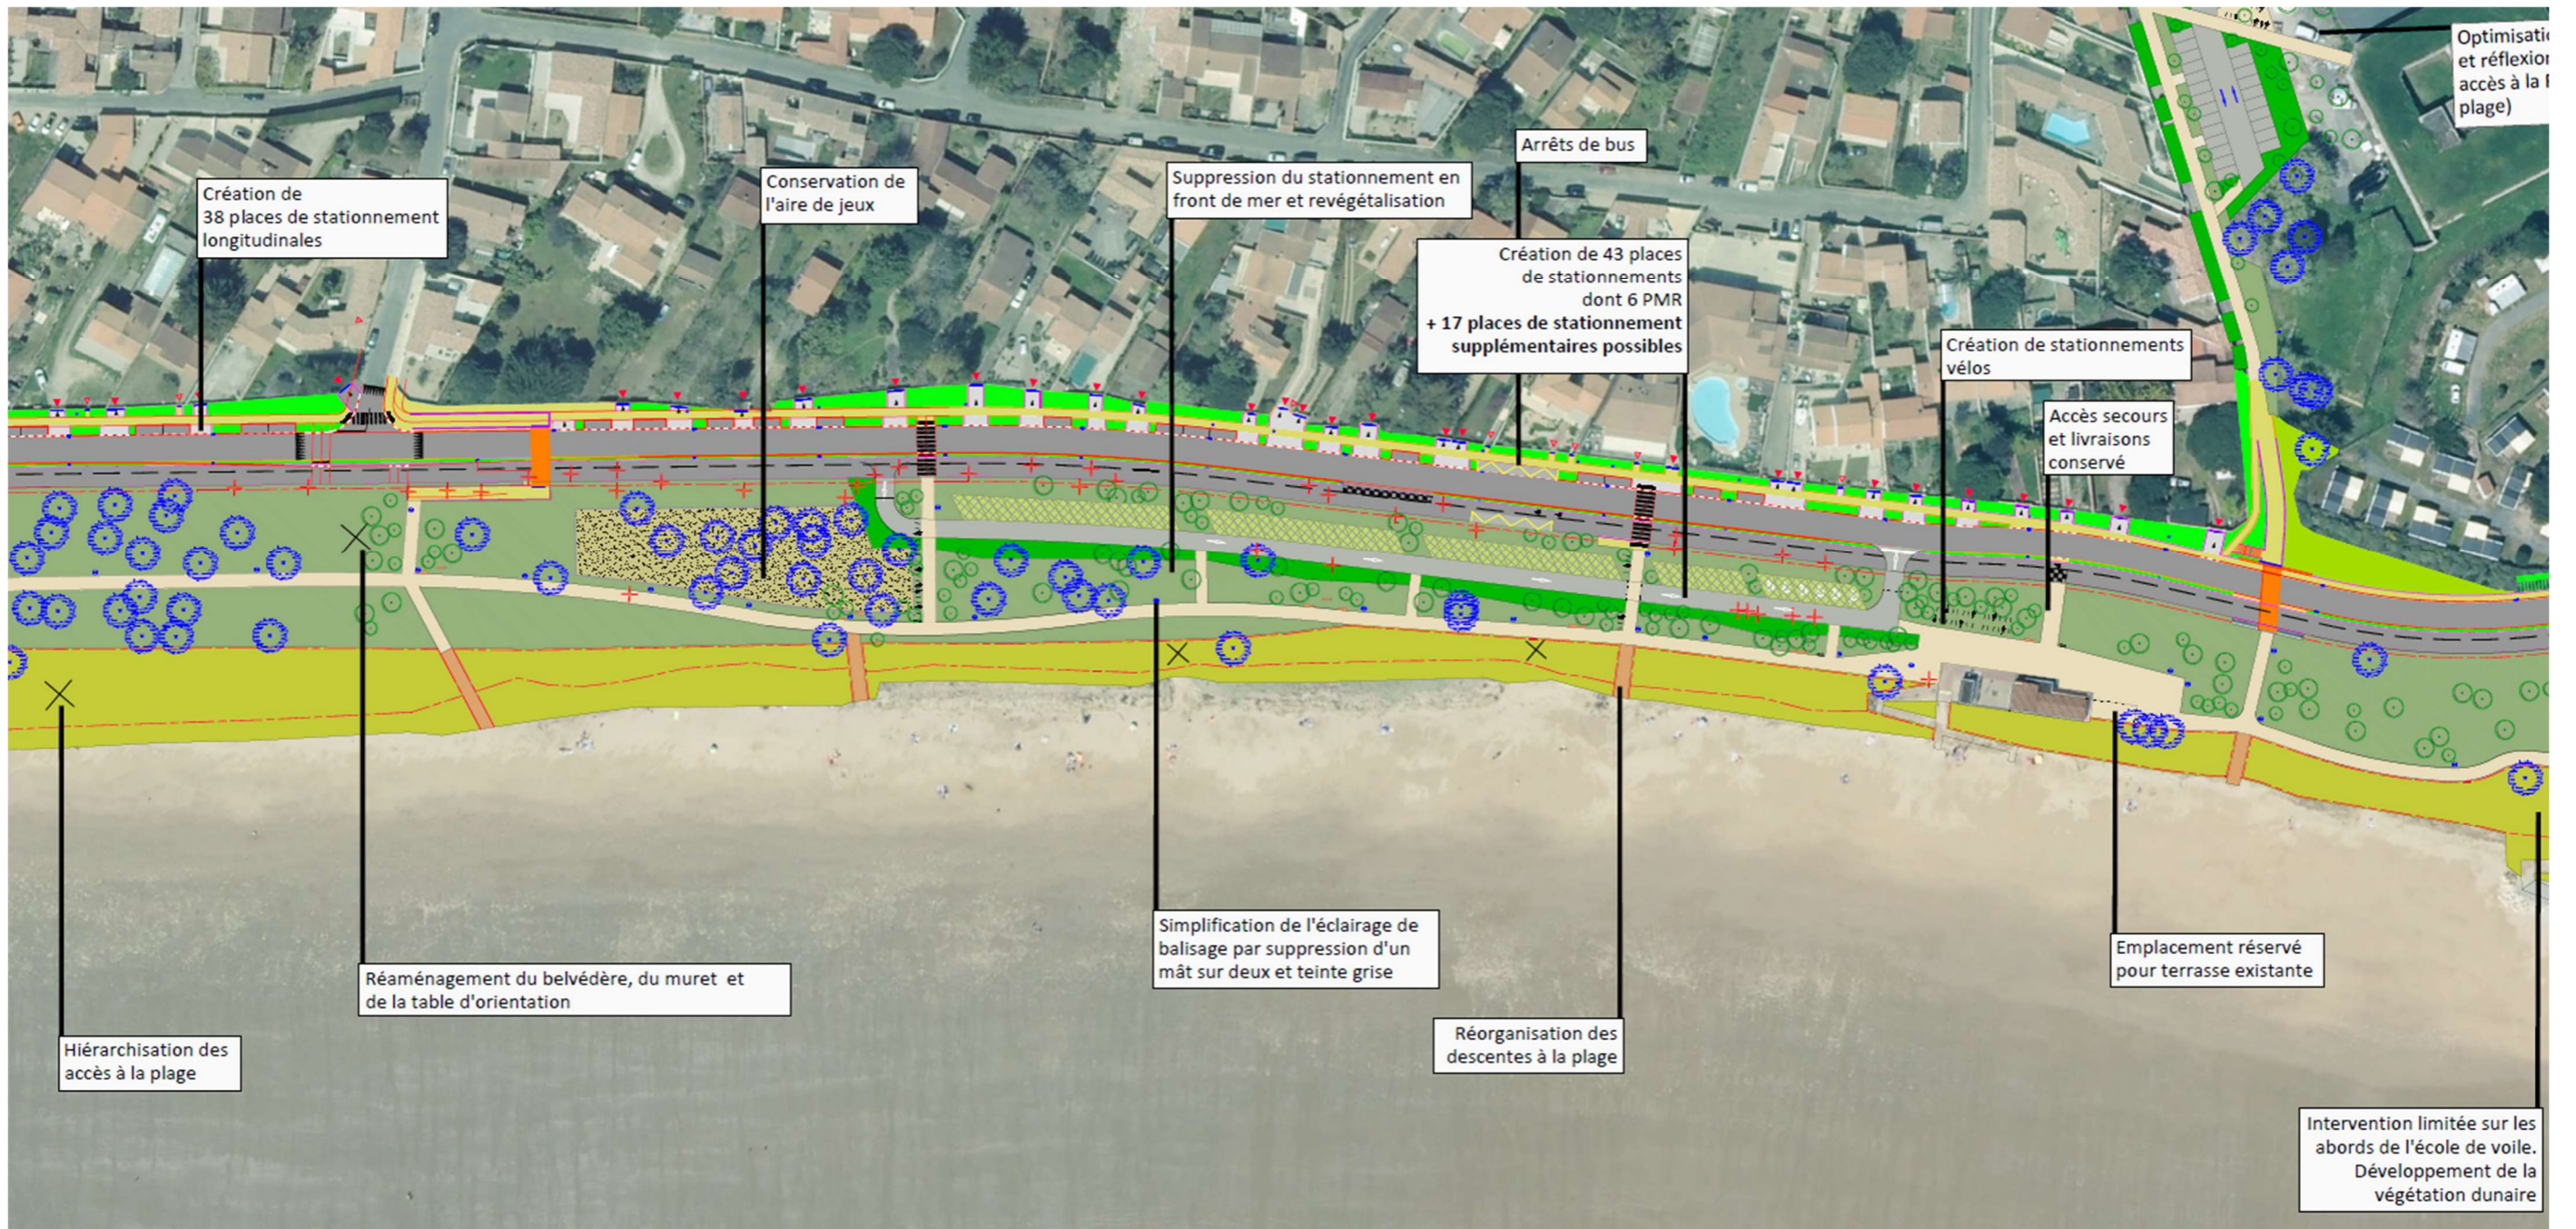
Plan du projet d'aménagement « 2. Aménagement du site propre et requalification de la plage sud de Rivedoux » (2)
